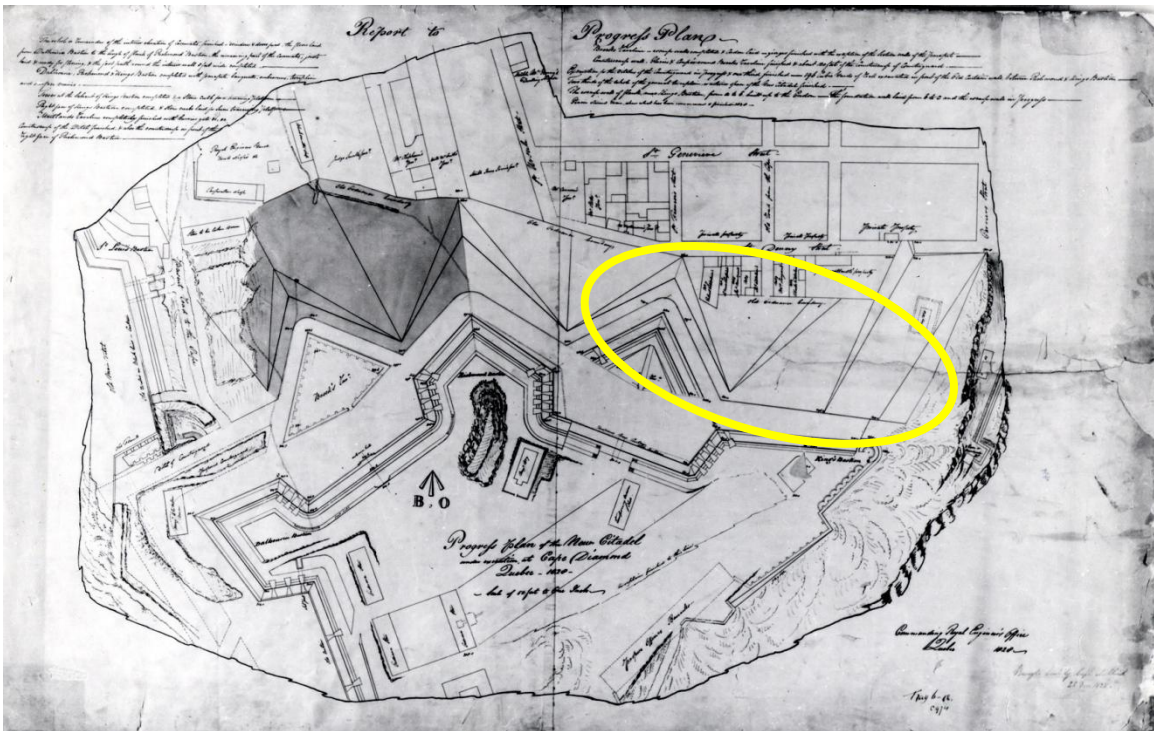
plan de 1828 - la contrescarpe actuelle est construite et le glacis est aménagé (132-00-ic-24)
